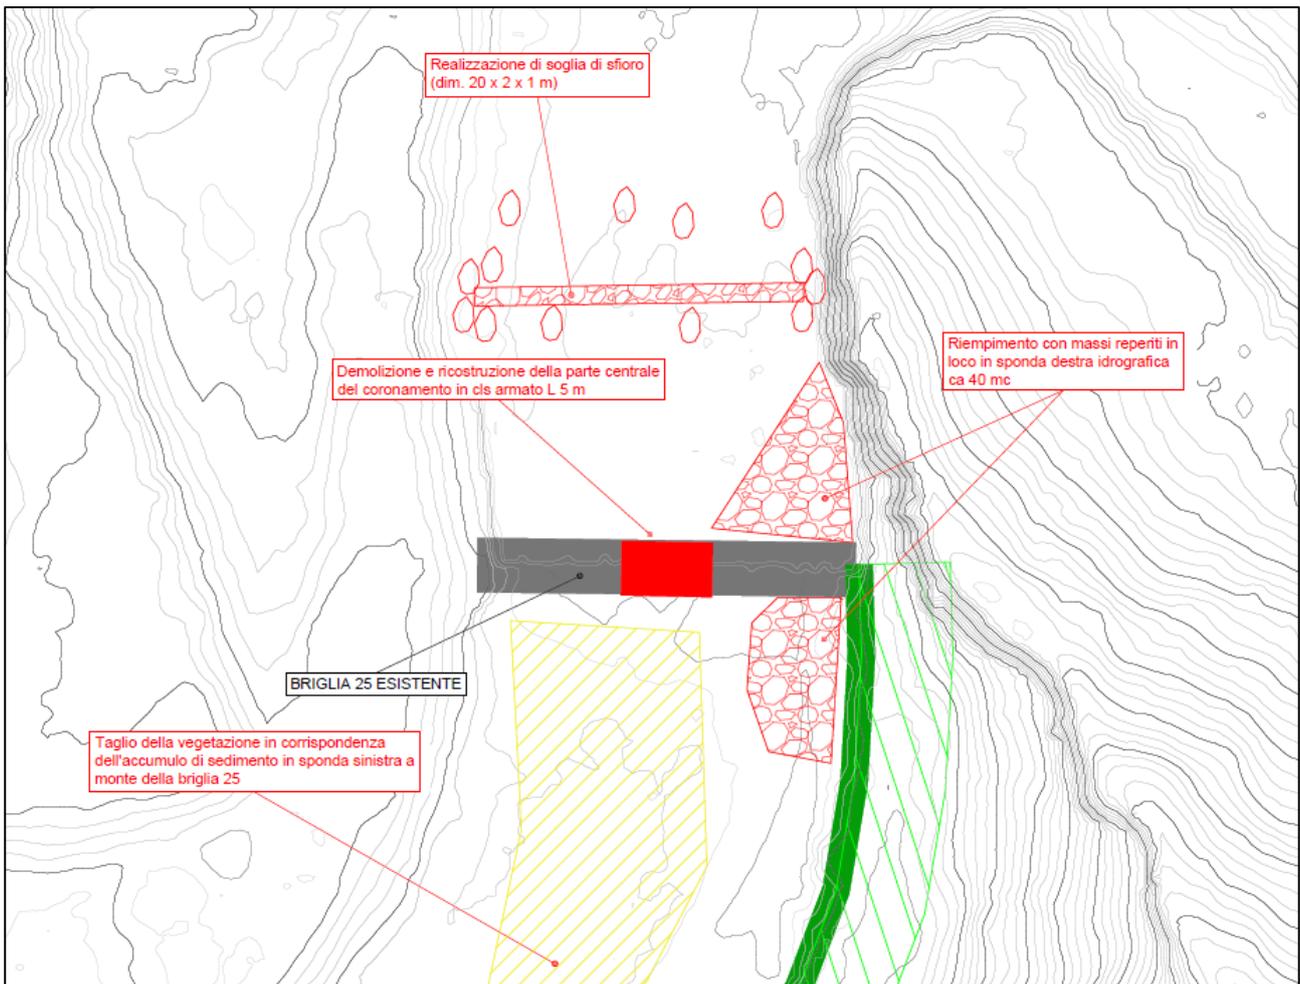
ESTRATTO PLANIMETRIA DI PROGETTO CON SCHEMATIZZATI GLI INTERVENTI PREVISTI
